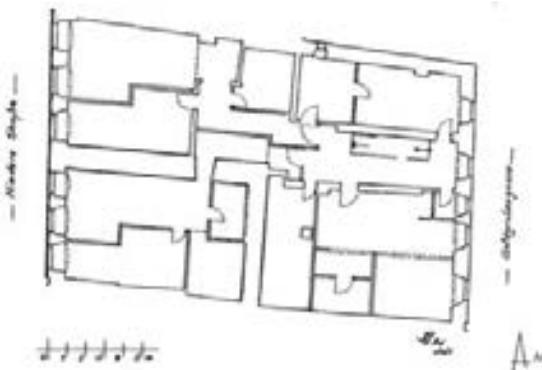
Villingen, Niedere Straße 37, Grundriss 1. Obergeschoss.
